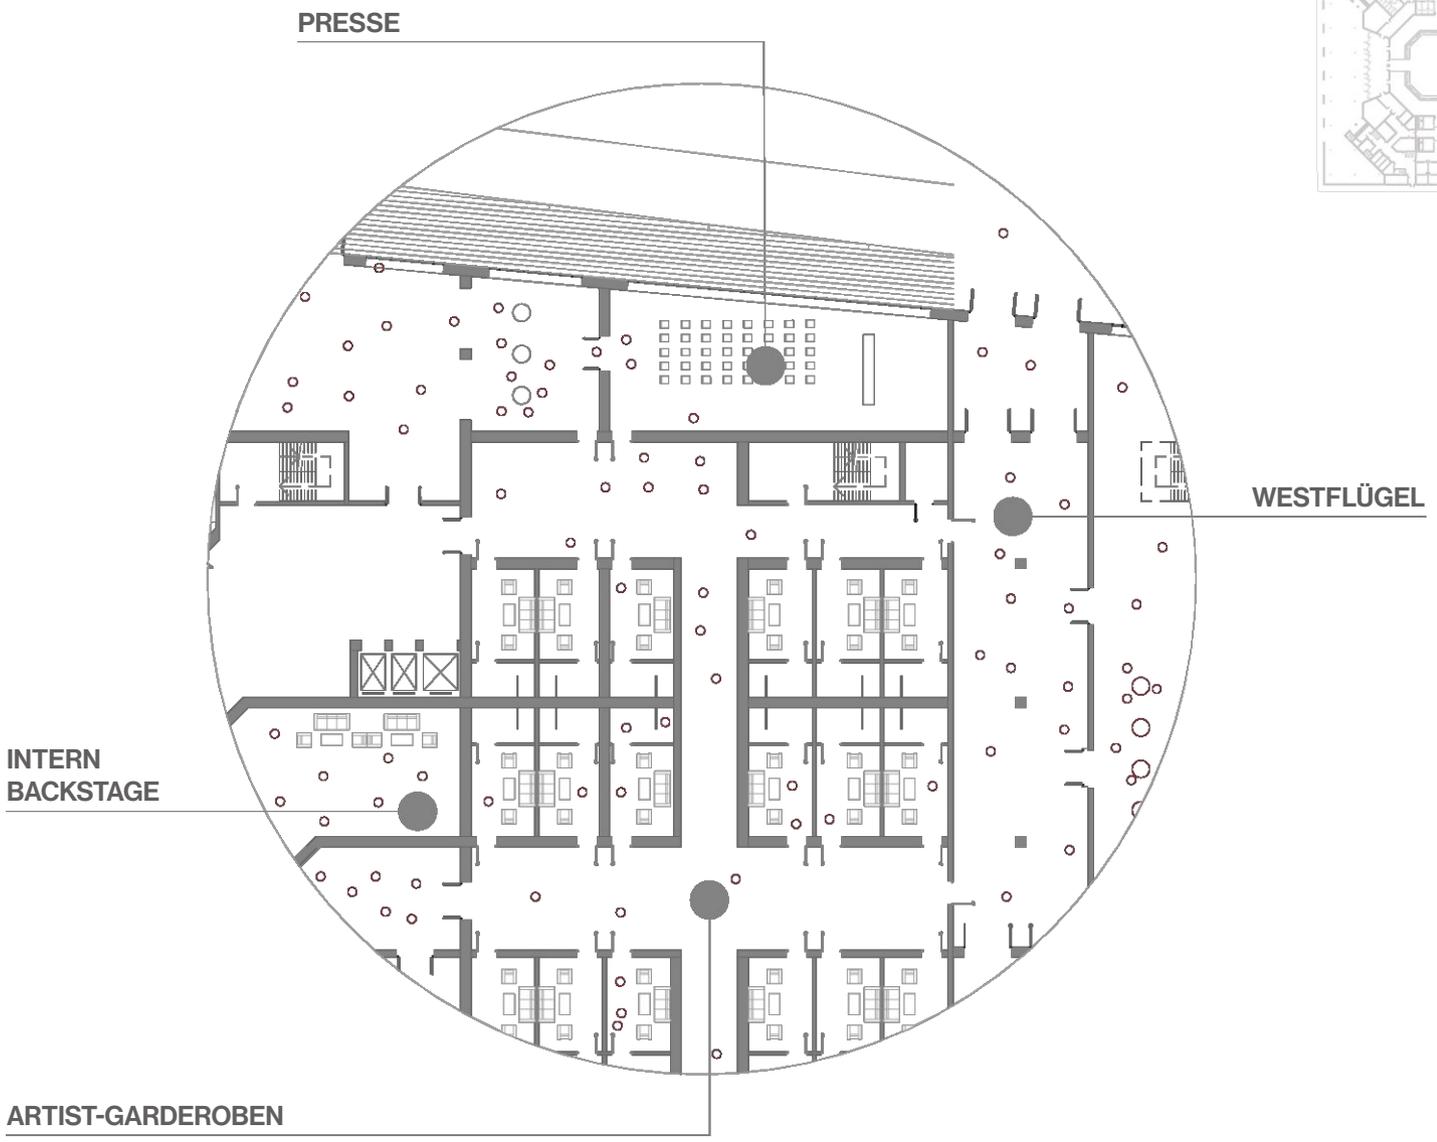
Grundriss EG Zoom Westflügel 1
